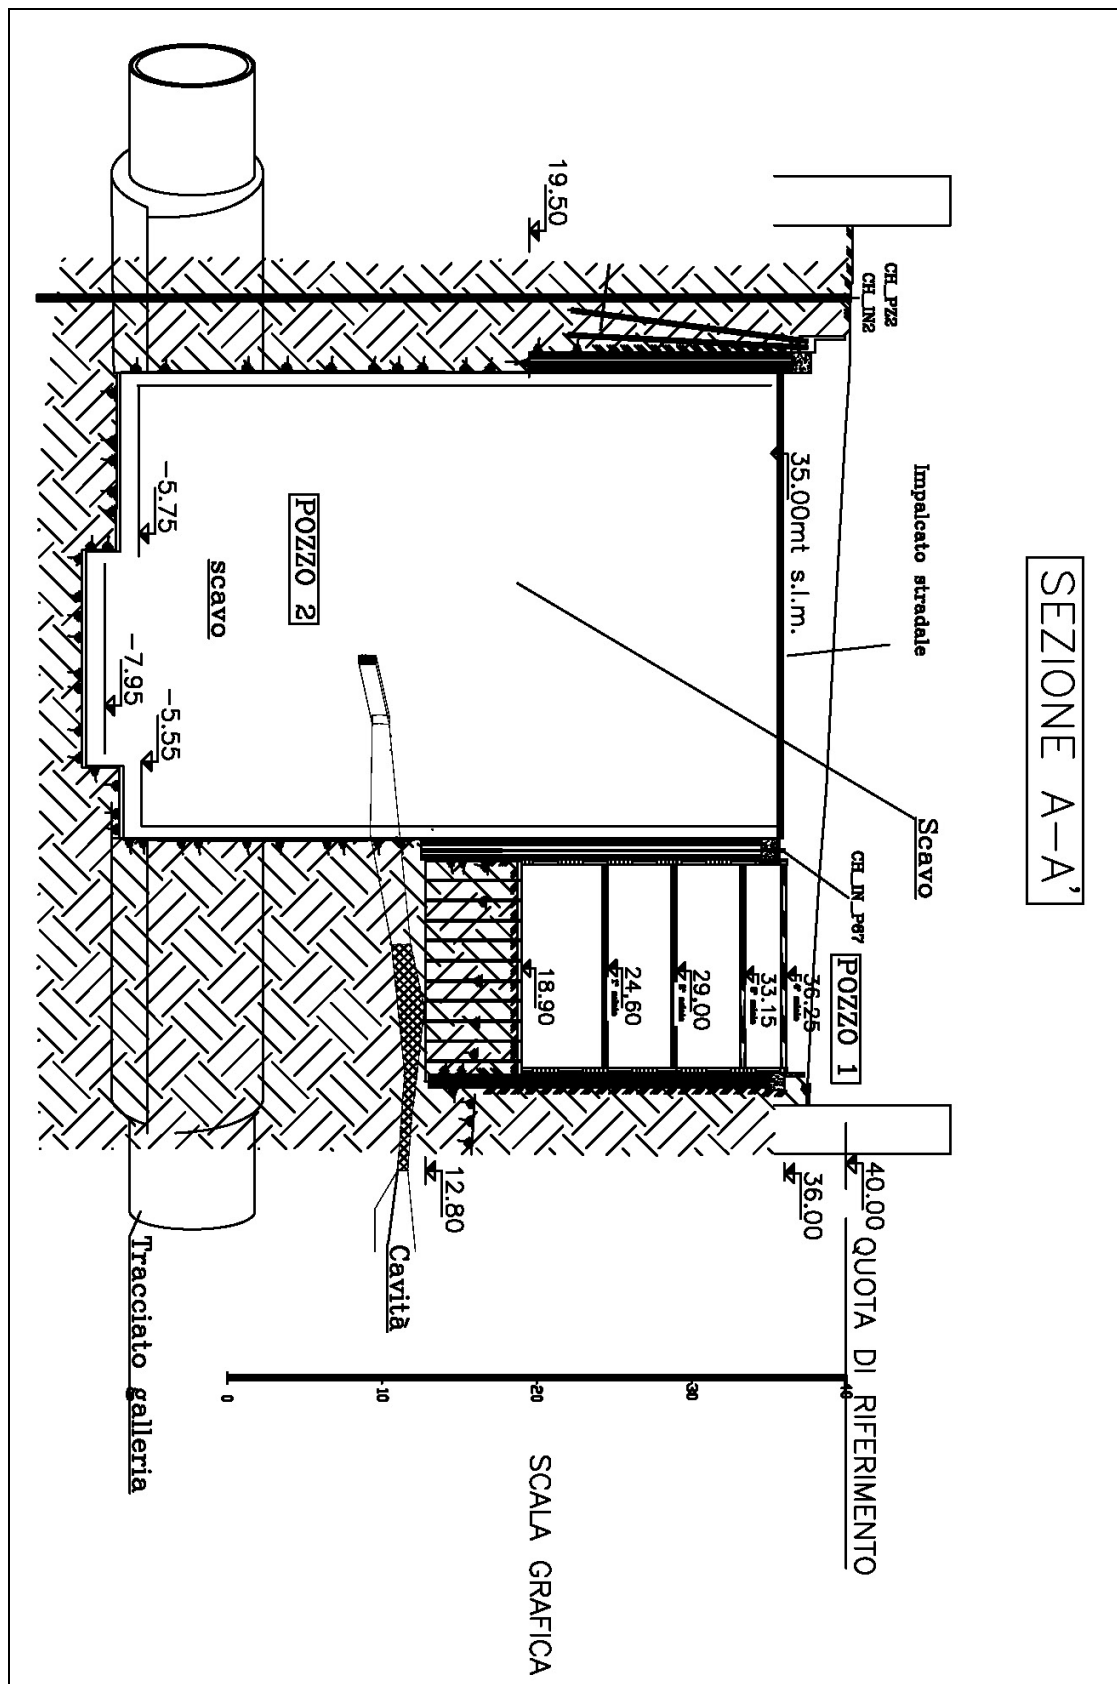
Sezione A-A' pozzo stazione, raffigurante la suddivisione in aree di lavoro.
